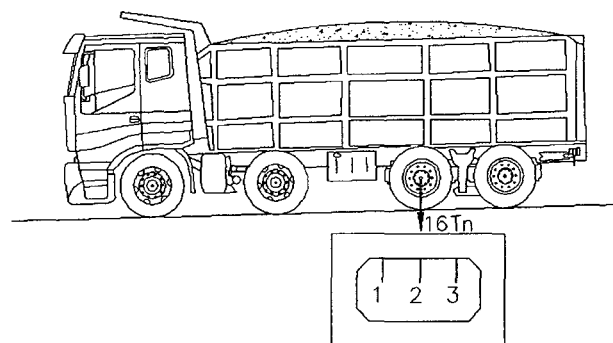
Vista transversal de alcantarilla con el camión para la prueba de junta con carga
